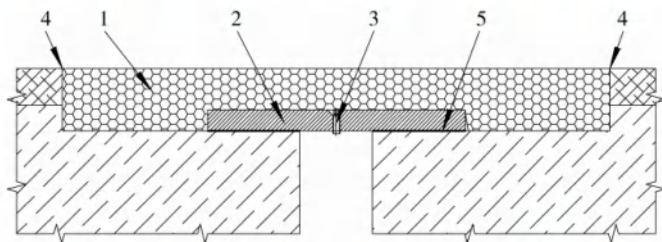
沥青混凝土填充式伸缩装置构造截面示意图
